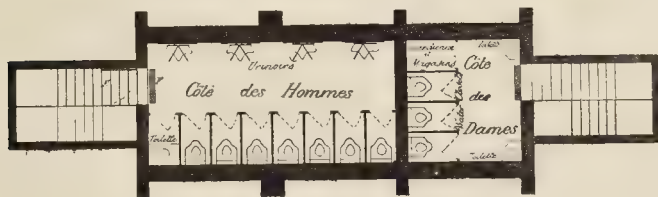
Wellington street (strand) (plan du sous-sol).
